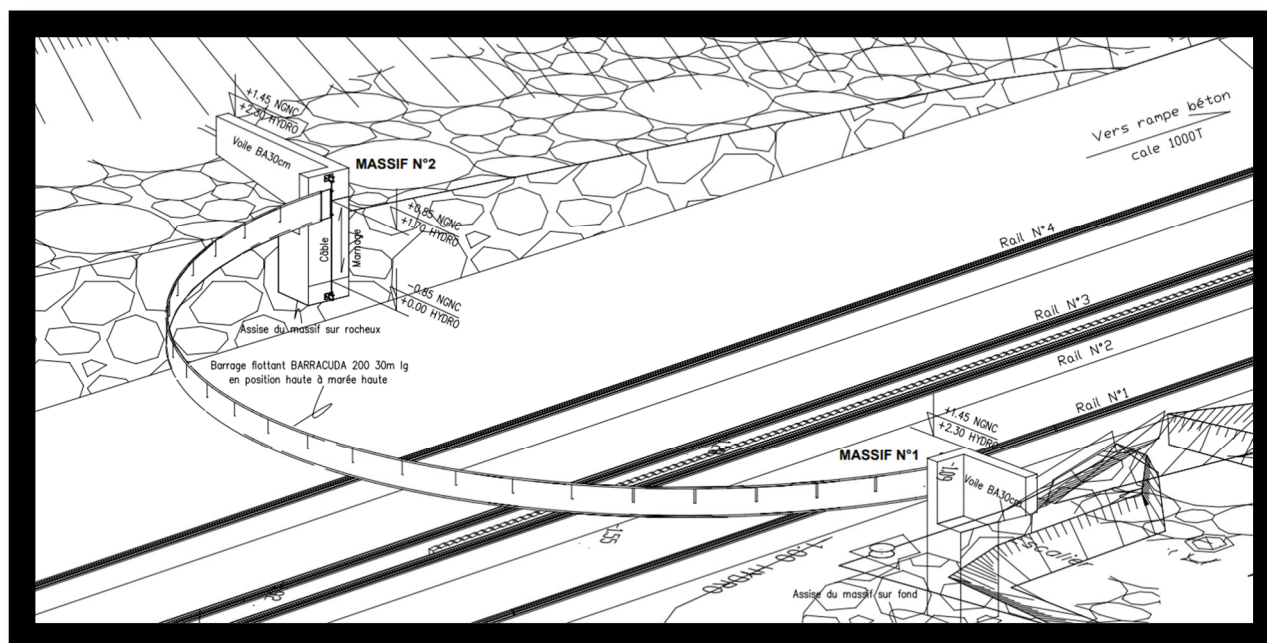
Principe d'installation du barrage flottant au niveau de la cale de halage 1000 T
